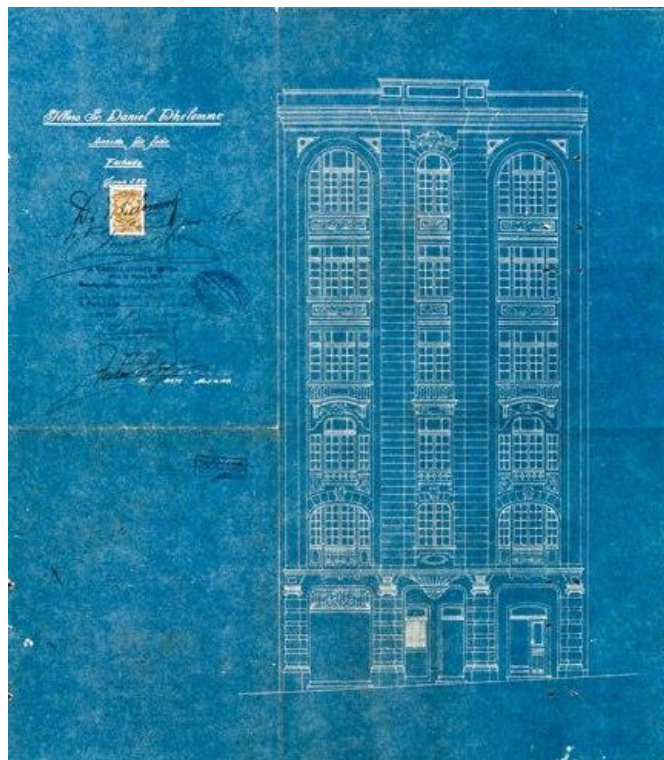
Desenho original da fachada executada. Desenho das plantas da edificação executada.
